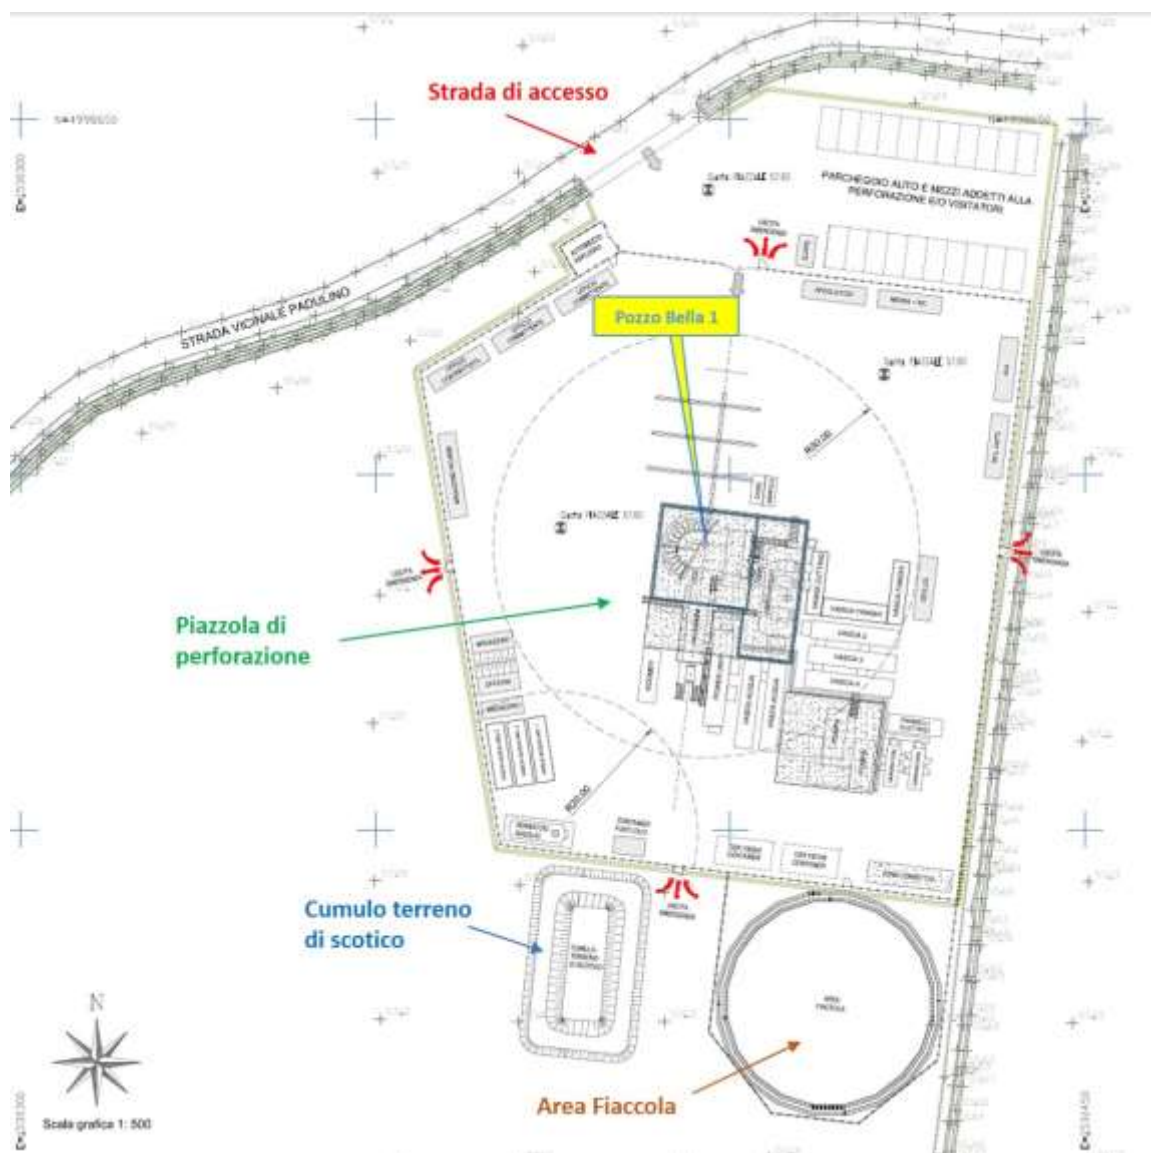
Planimetria di cantiere, postazione sonda Bella 1
